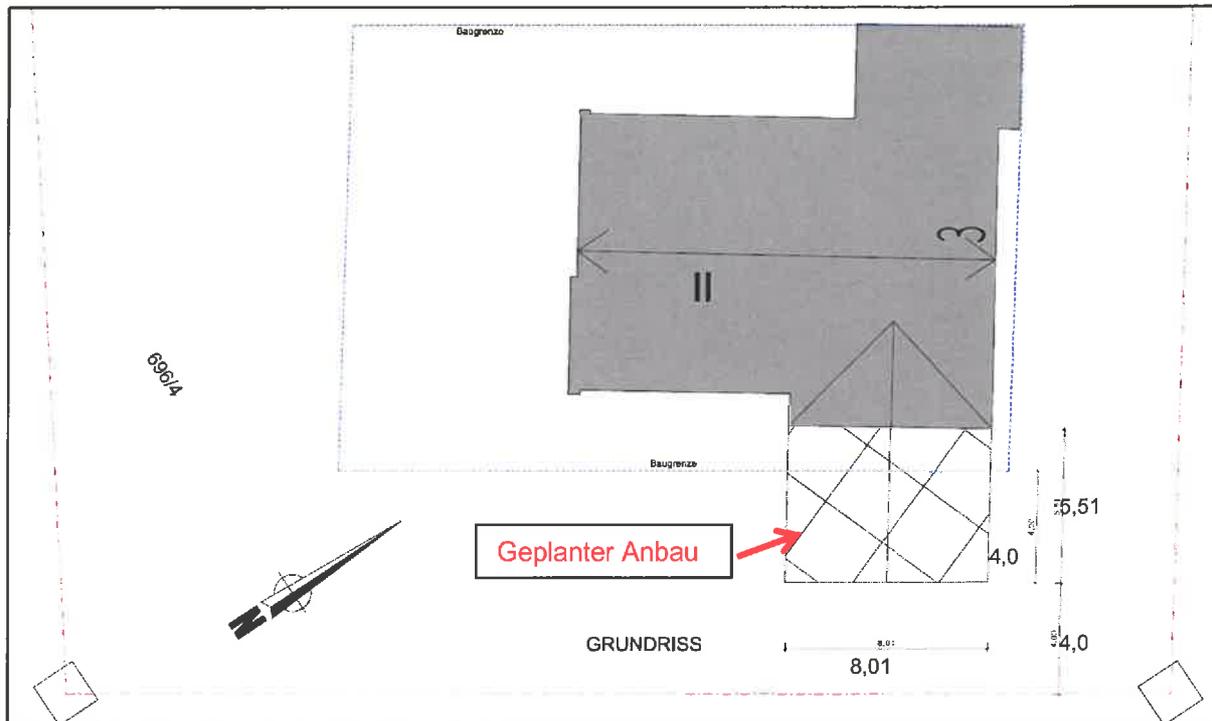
Bauvoranfrage geplanter Anbau Flurstück 696/4 (IB Lerach, Planstand 05.08.2015)
